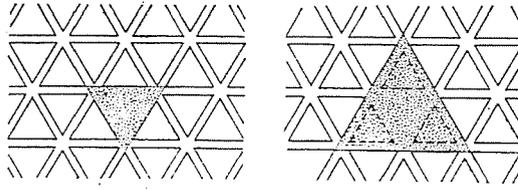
Verstärkte Pilzkopf-Ausführungen: A: Vollpilzkopf; B: für 50-cm-Decke: Kasette 40 cm + Aufbeton 10 cm
